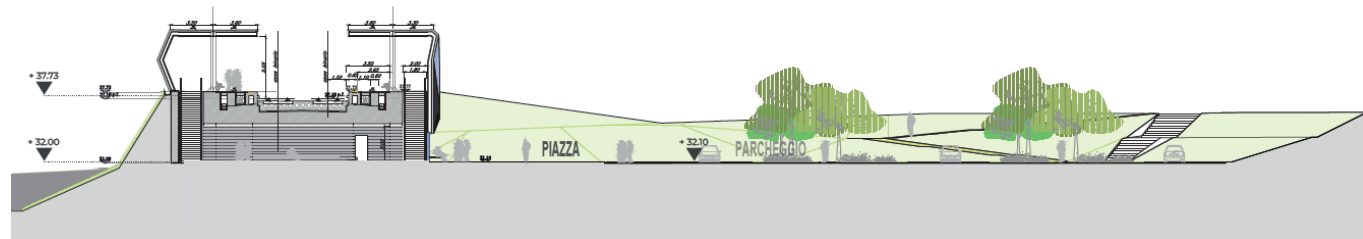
Nuova stazione ferroviaria di Augusta: Sezione trasversale
